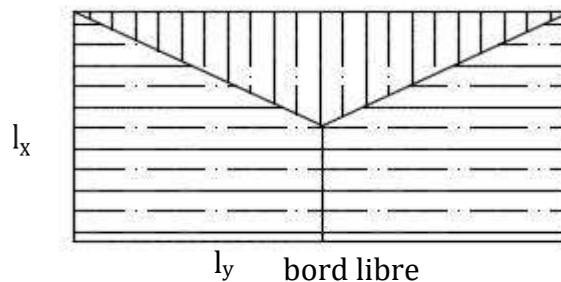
Schémas de modélisation des poutres sur 3 appuis
